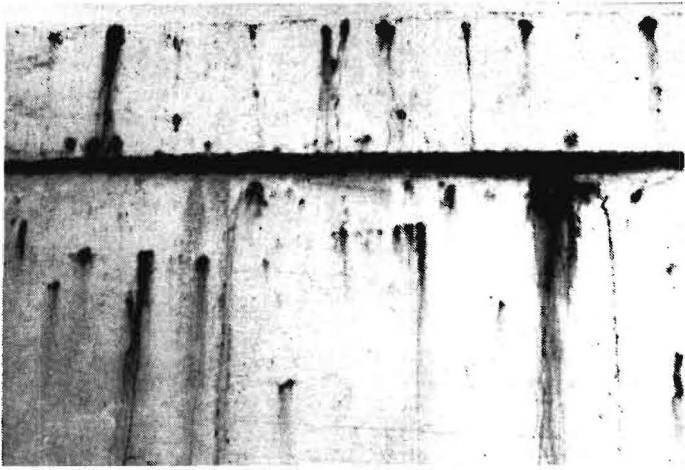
Korrodierte Bewehrungsstäbe von Stahlbetonelementen am Lagertyp P 220 infolge nicht mehr funktionsfähiger Schutzanstriche an den Innenwänden
